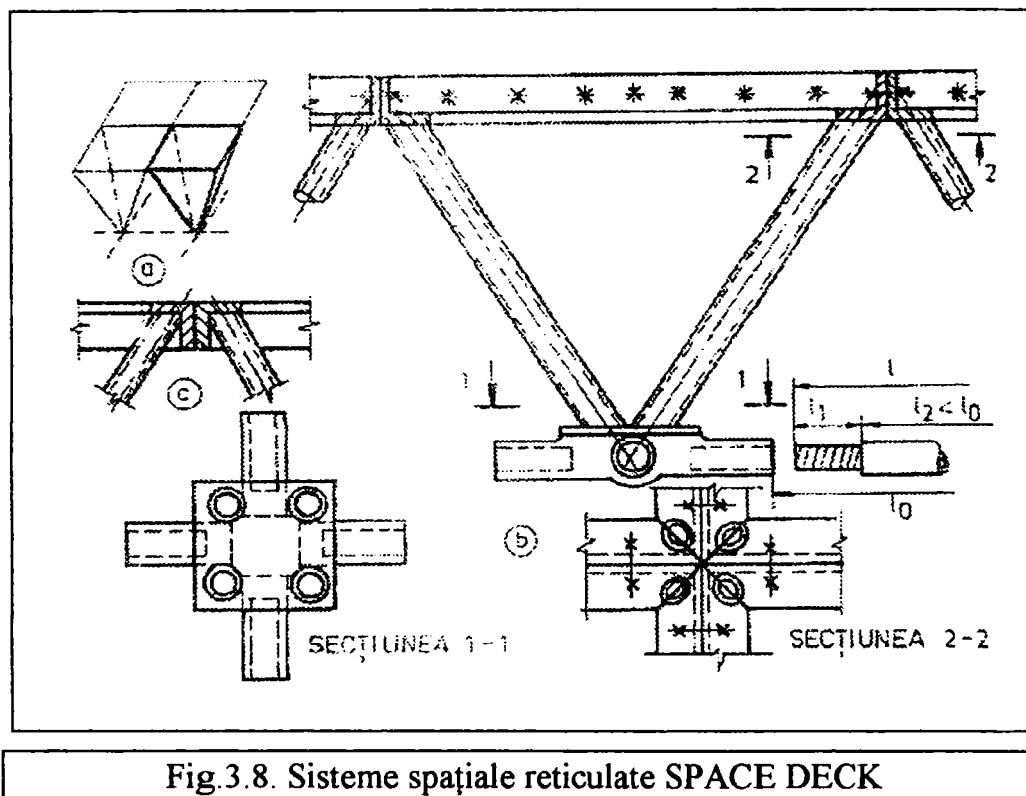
Sisteme spațiale reticulate SPACE DECK
